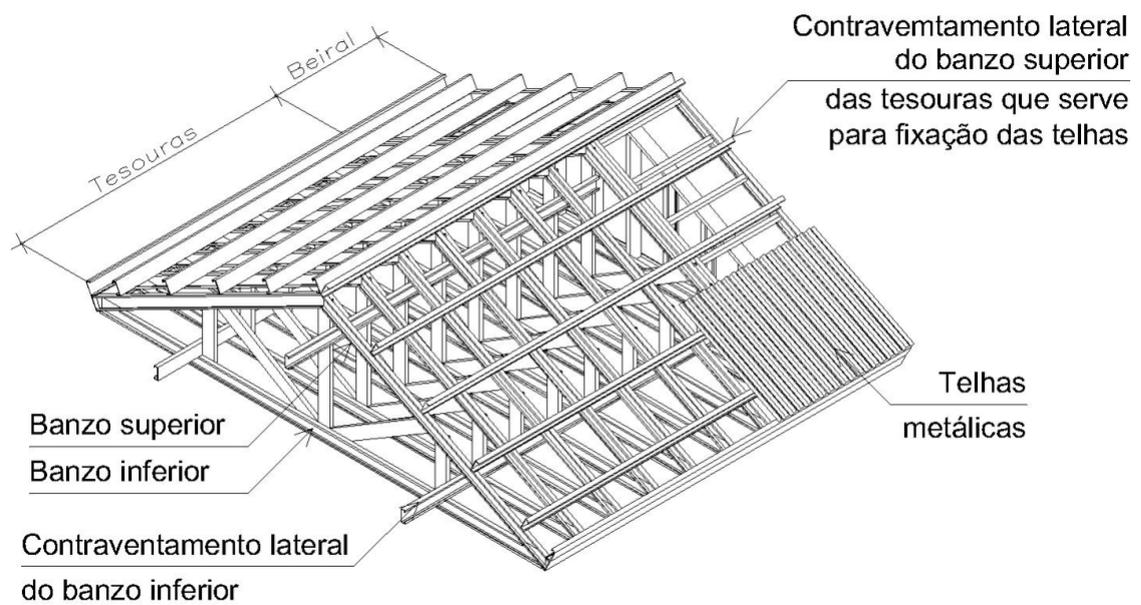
Telhado estruturado com tesouras com cobertura em telha metálica.
